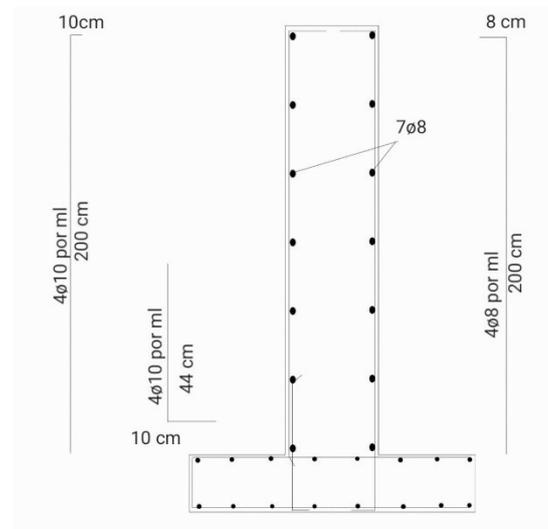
Disposición del armado para un muro de dos metros y canto constante (Fuente propia)
